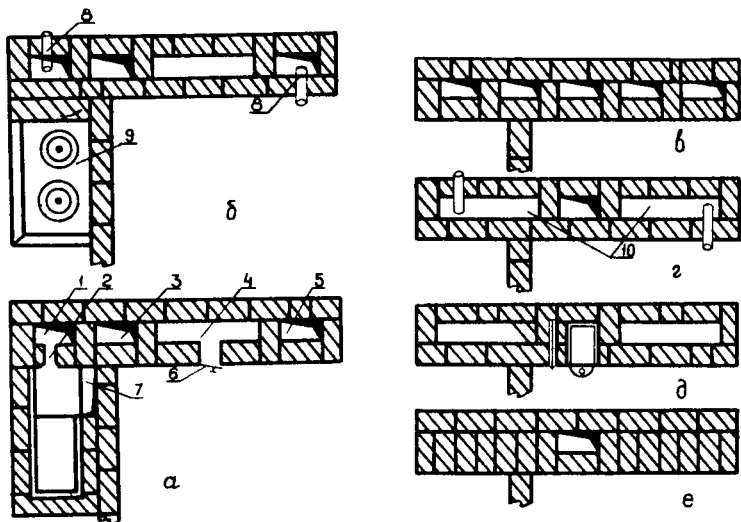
Кладка печи № 4 с 11-го по 35-й ряд: а — 11-й ряд; б — 12—14-й ряды; в — 15—25-й ряды; г — 26—28-й ряды; д — 29—31-й ряды; е — 32—35-й ряды; 1 — первый дымооборот; 2 — подсосный канал; 3 — второй дымооборот; 4 — второй горизонтальный канал; 5 — третий дымооборот; 6 — окно чистки; 7 — опускной канал; 8 — металлические трубные нагреватели; 9 — плита; 10 — перевалы
